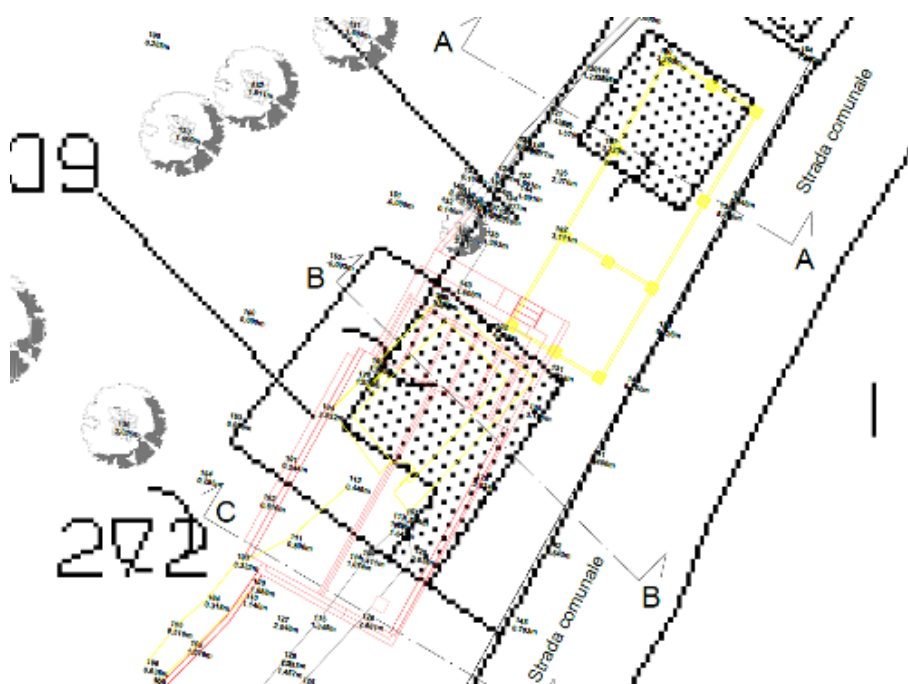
stralcio tavola 04 ProgeTec – planimetria raffronto
